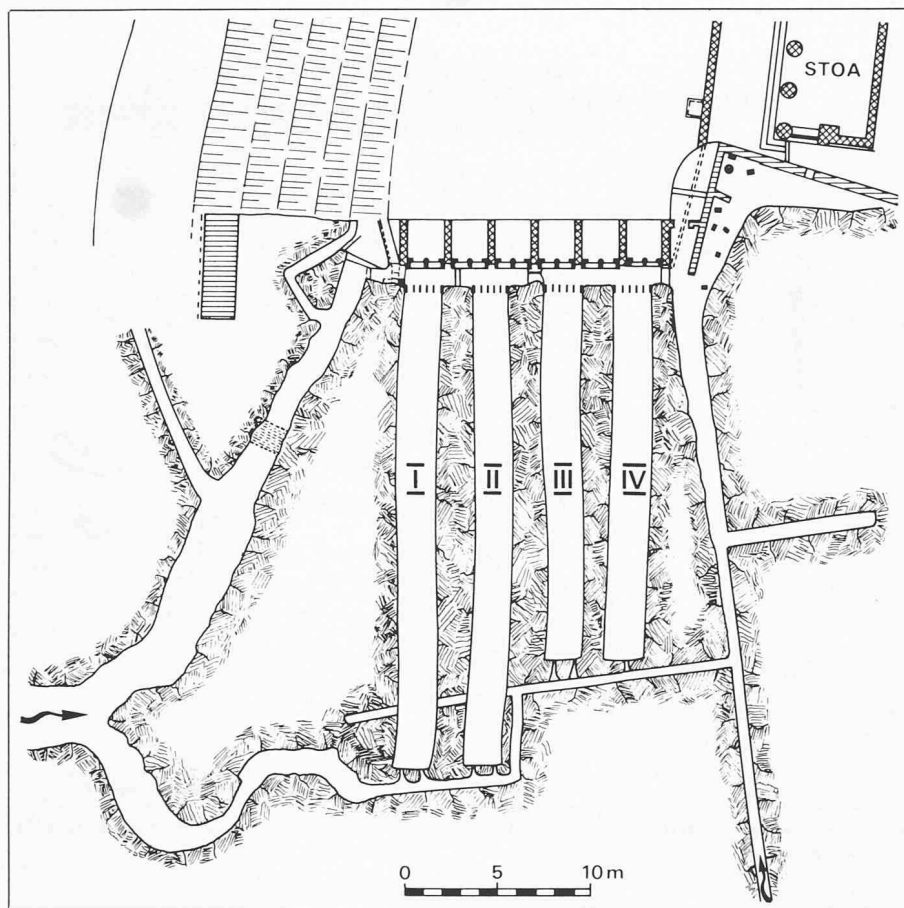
Grundriss der Reservoirkammern und der griechischen Schöpfbecken des Peirene-Brunnens in Korinth (nach [12])
